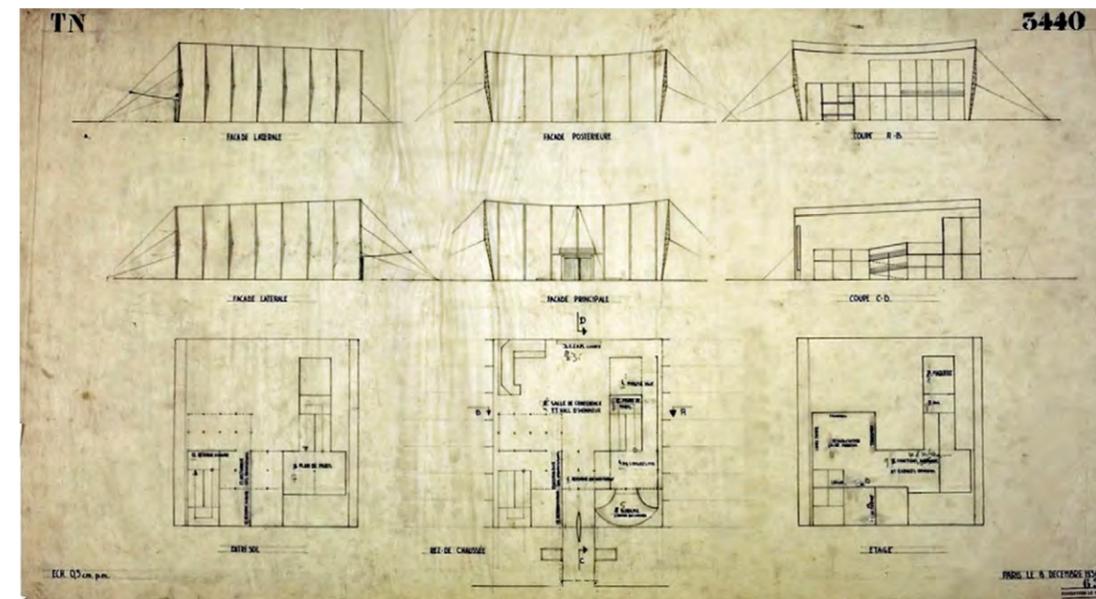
Planos definitivos del proyecto del Pavillon des Temps Nouveaux.
